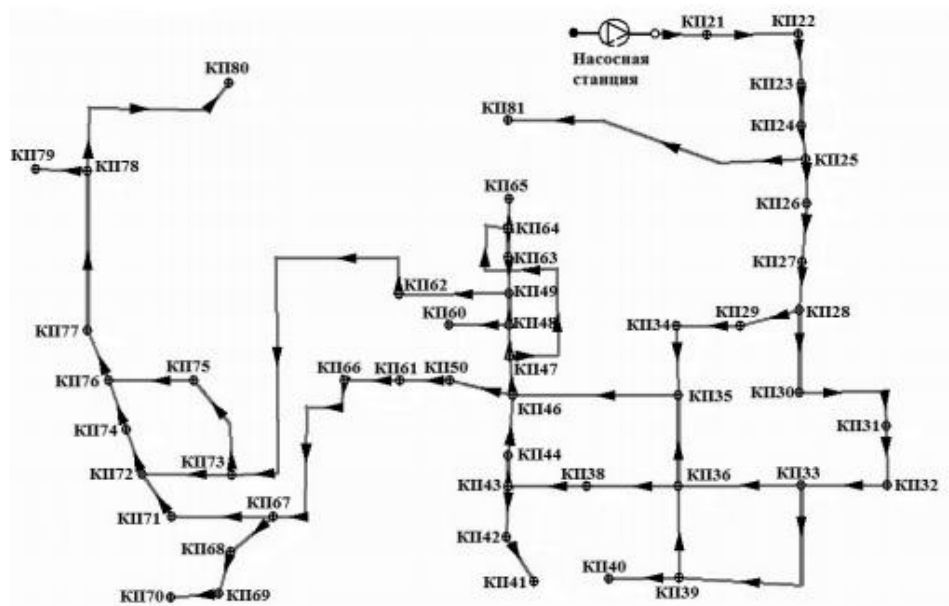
Схема водопроводной сети ветки «Поселковая»
